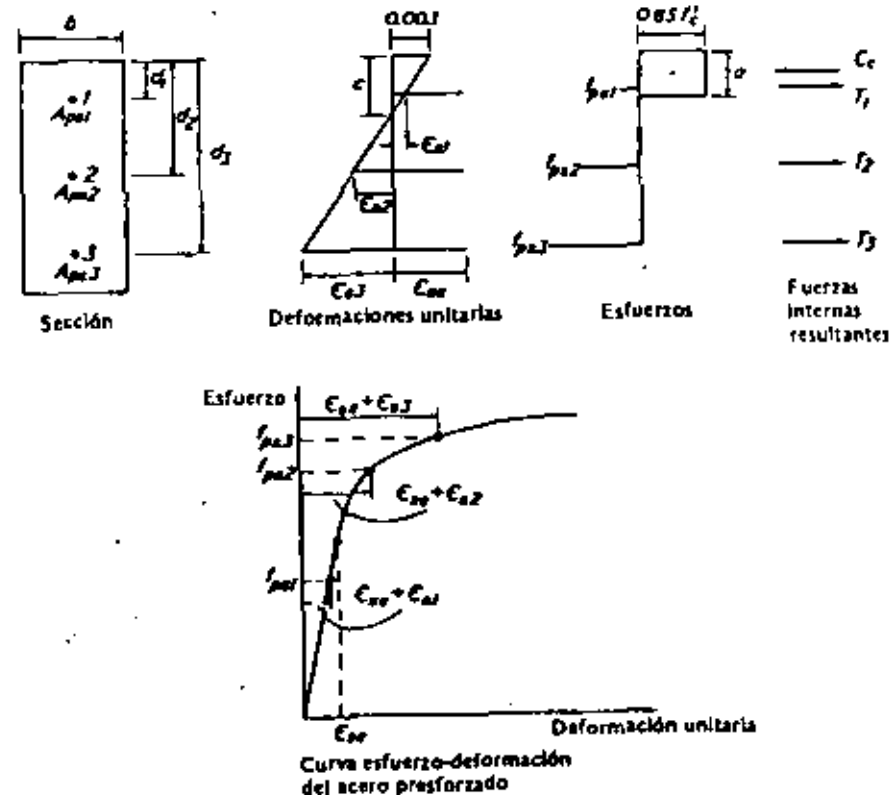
Sección de concreto presforzado al alcanzarse la resistencia a flexión.
